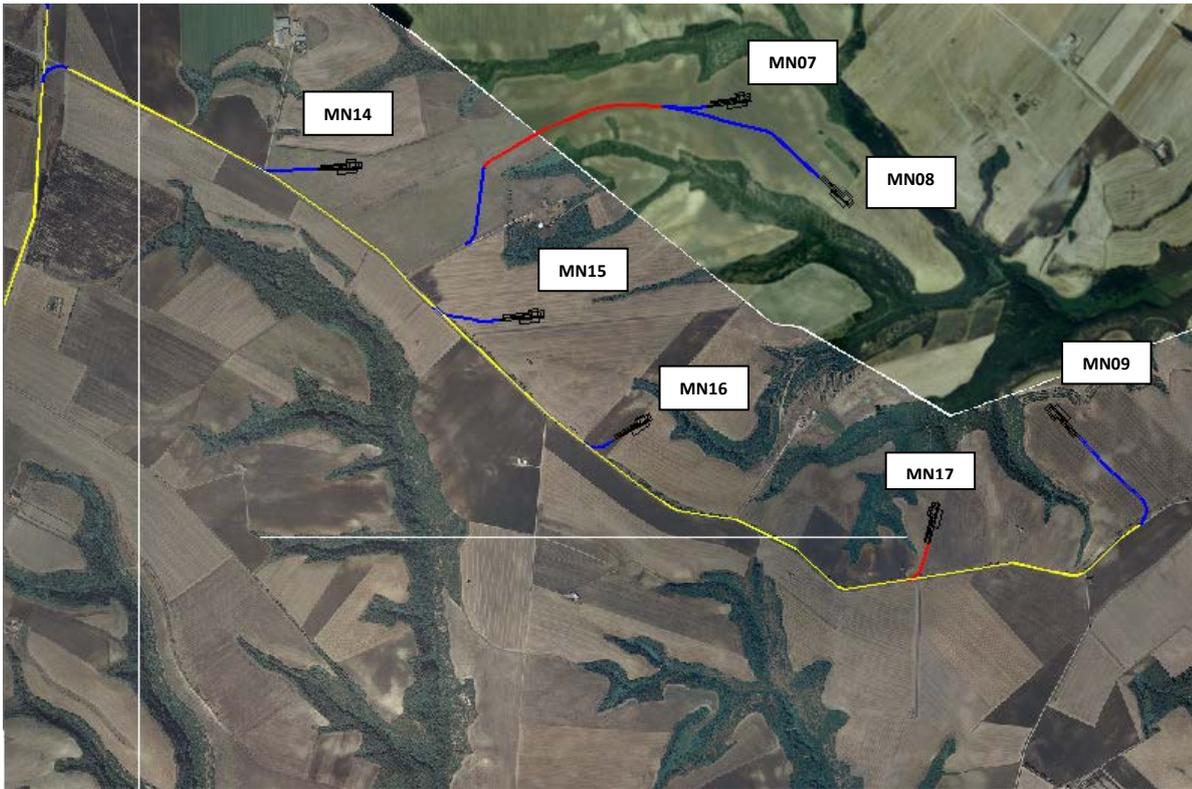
Planimetria degli accessi alle WTG dalla Strada Provinciale 76
